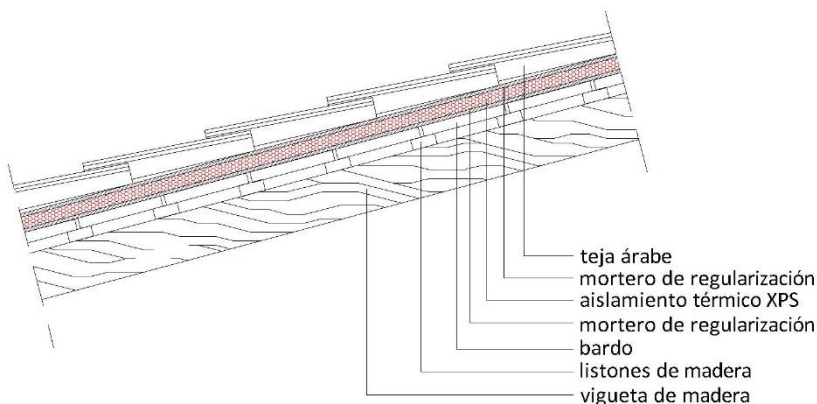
Detalle faldón con aislamiento térmico. 2015. Fuente propia.
